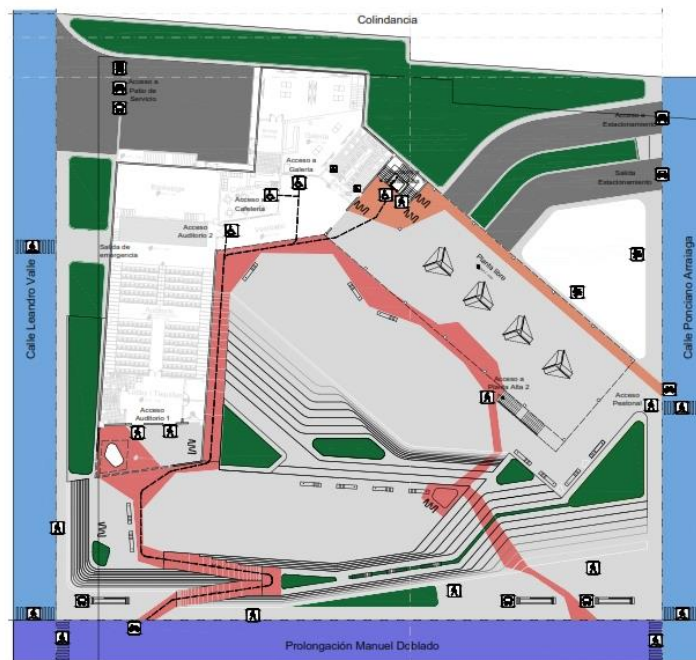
Planta de conjunta con las rutas de acceso al terreno. Elaboración propia.
